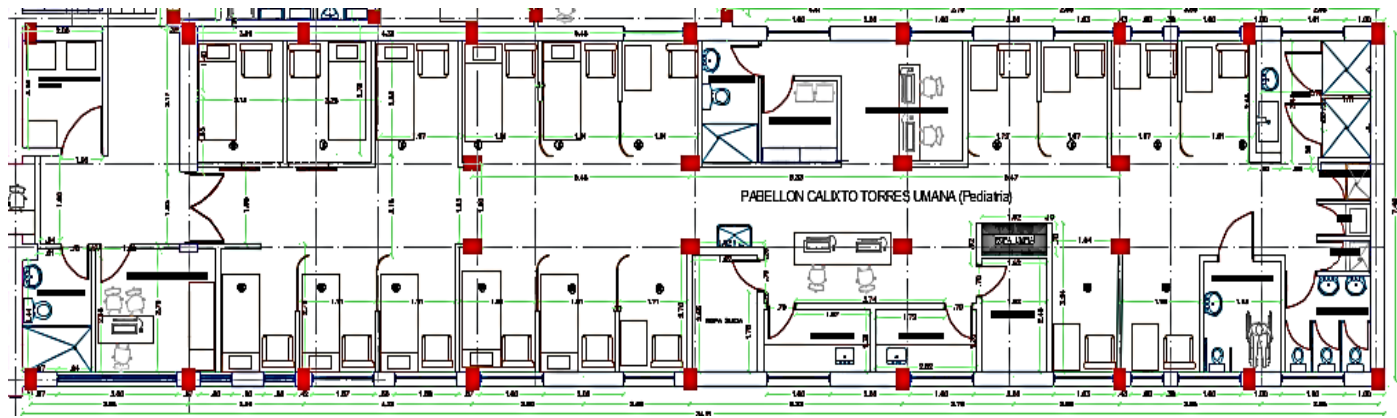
Planta Estructural Zona B, planta primer piso. Fuente: Autor.
